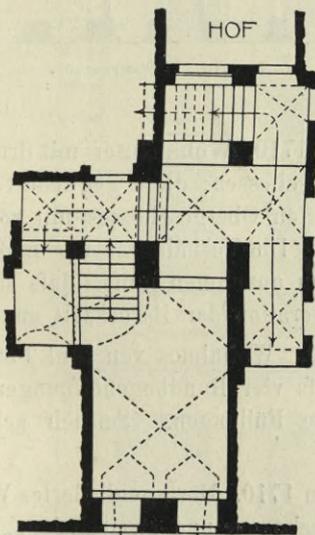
Innere Lauenstraße Nr. 3, Grundriß der Halle. Zwischenstock.
